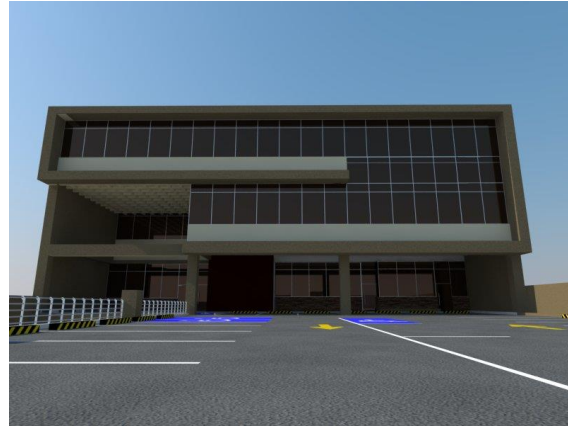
Fachada posterior. Tercer propuesta. Autor: Carmen López
